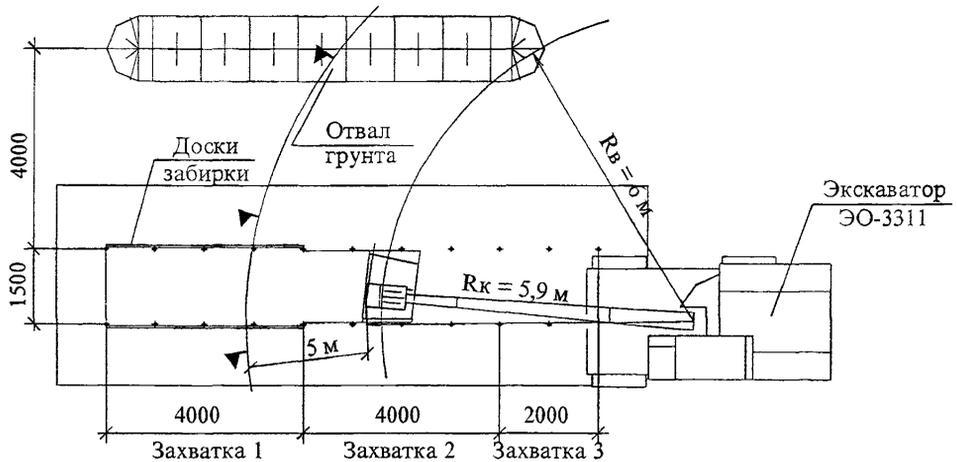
Схемы производства работ по разработке грунта траншеи глубокого заложения с креплением стенок
